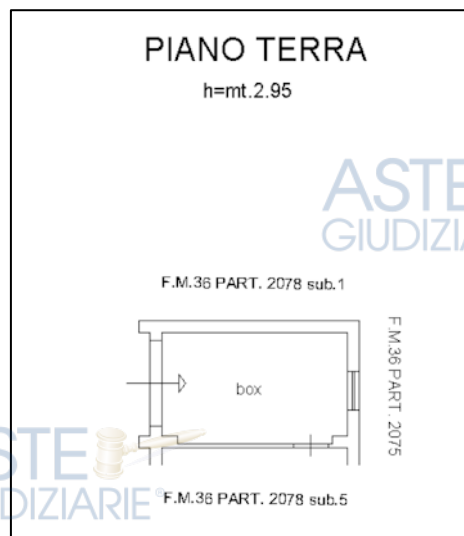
Estratto planimetria catastale sub 4 (ALLEGATO 4)
